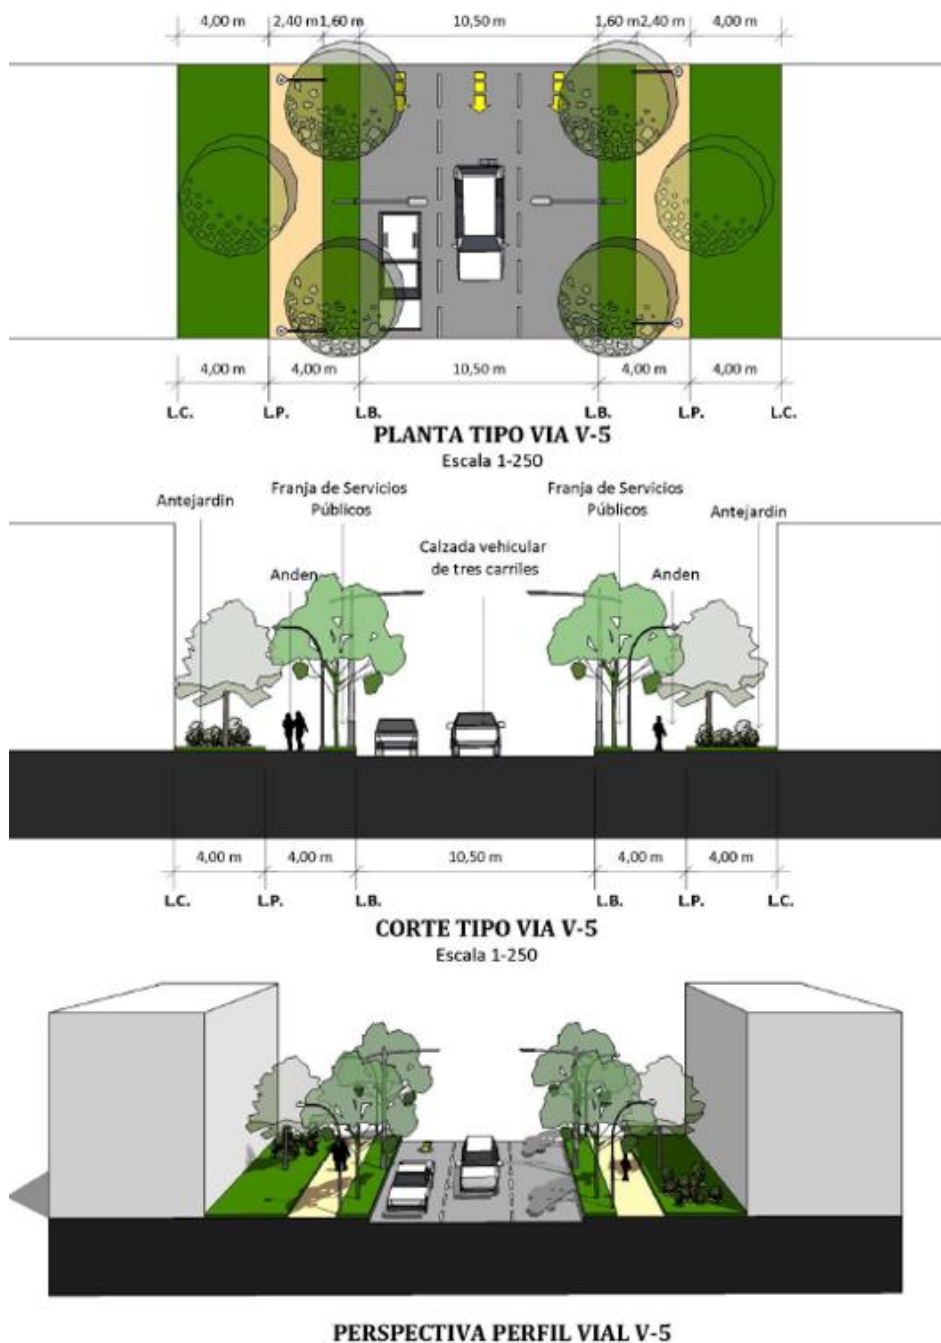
perfil en todos los sectores carreras 64B a la 76
